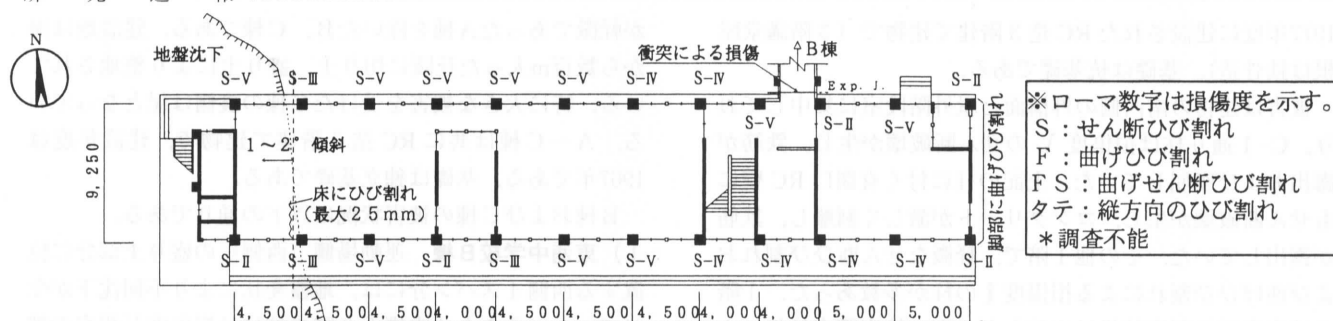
東浦中学校C棟の平面図と被害状況（1F）
